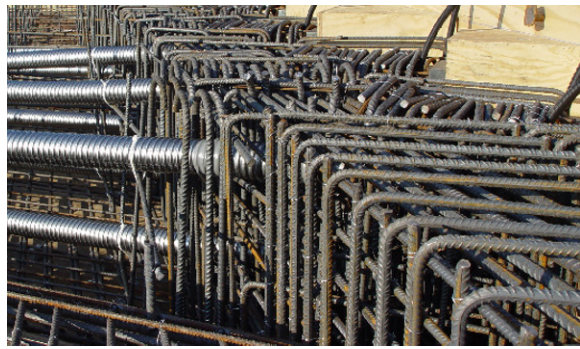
Aufbau einer Brückenüberbauplatte mit Spannstahlgliedern
